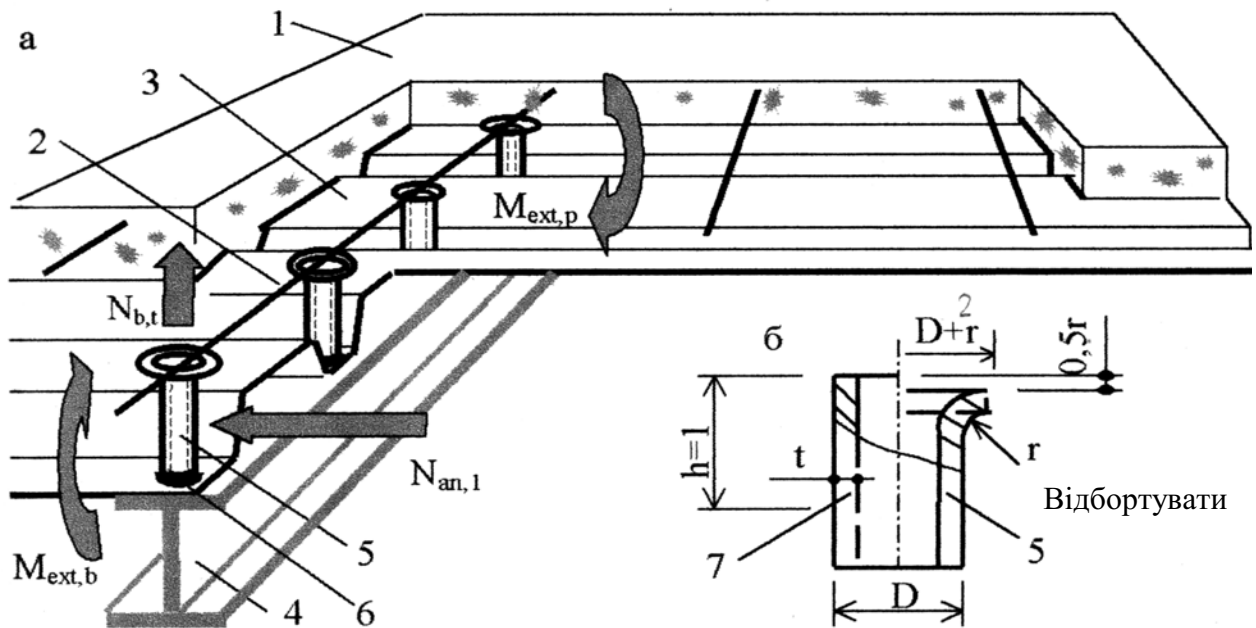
Монолітна залізобетонна плита з листовою гофрованою арматурою:
